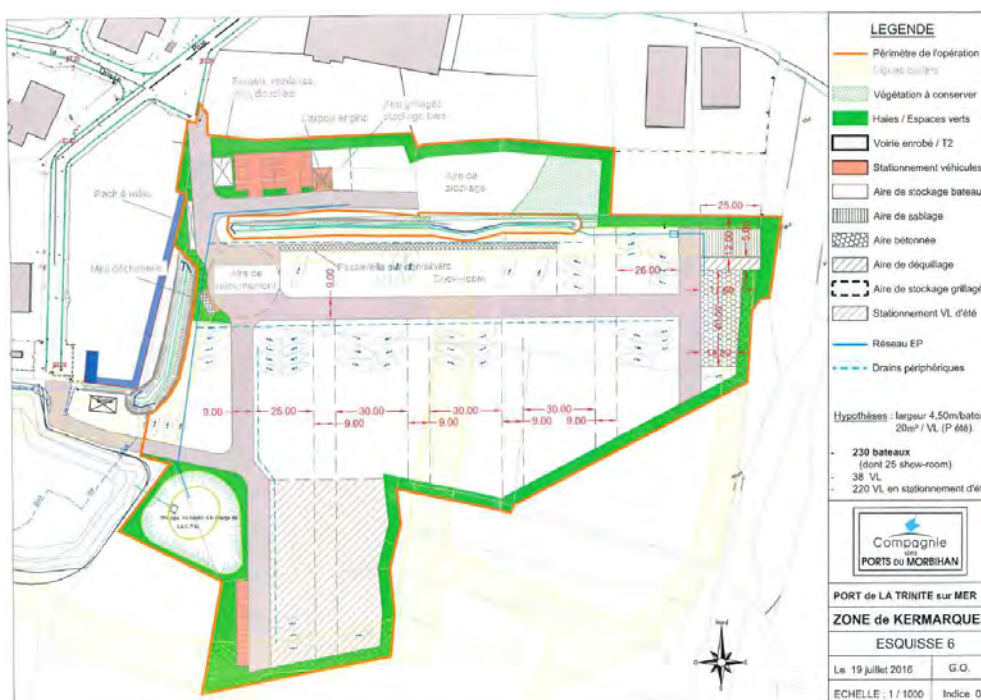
Plan projet de l'extension sud (CPM, juillet 2016)
